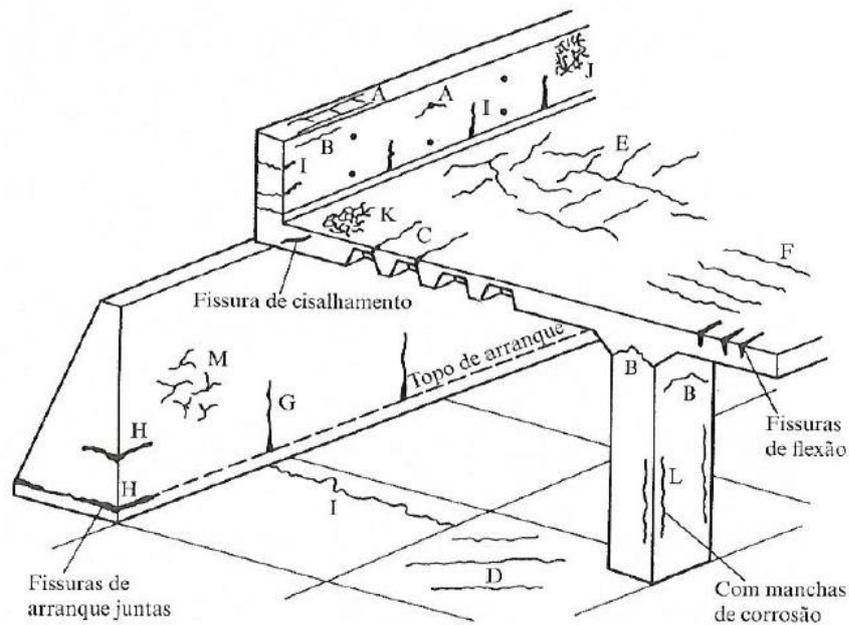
Ilustração dos tipos de fissuras – Fonte (NEVILLE p.250 *apud* CONCRETE SOCIETY N.22, 1982, p.38)
